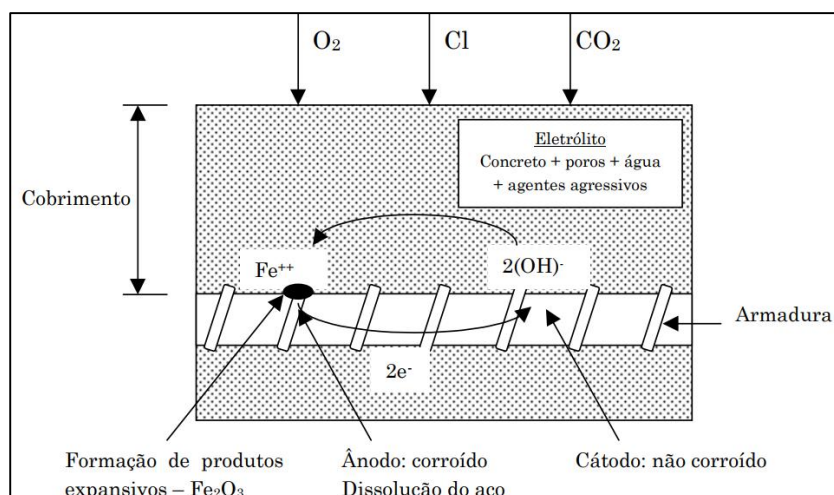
Modelo de corrosão das armaduras no concreto (ANDRADE, 2001)
